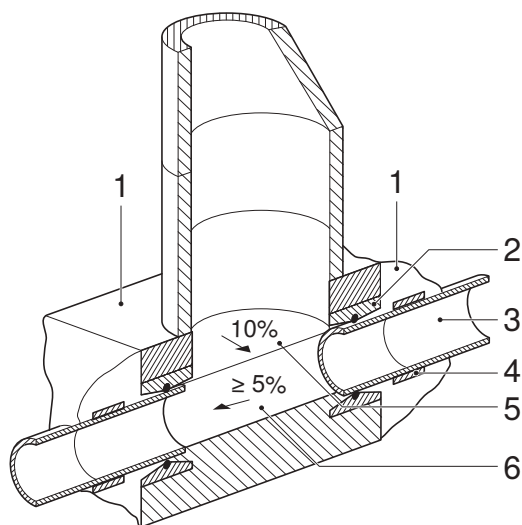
Napojení s prefabrikovanou šachtovou přípojkou
